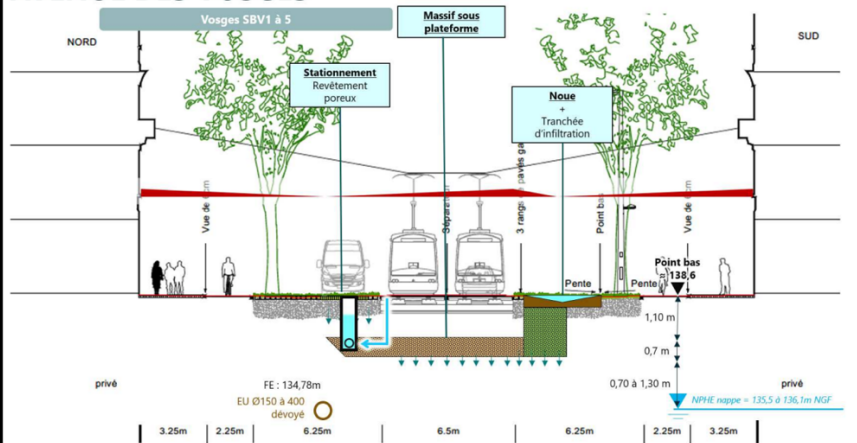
COUPE TYPE ASSAINISSEMENT AVENUE DES VOSGES (Source : GETAS AVP)
